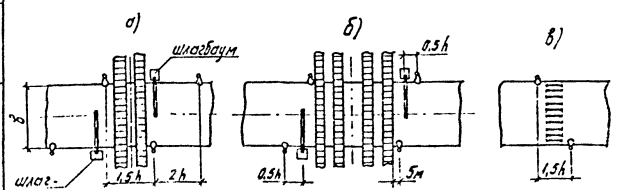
Схемы размещения светильников. а, б - на железнодорожных переездах, в - на пешеходном переходе.
